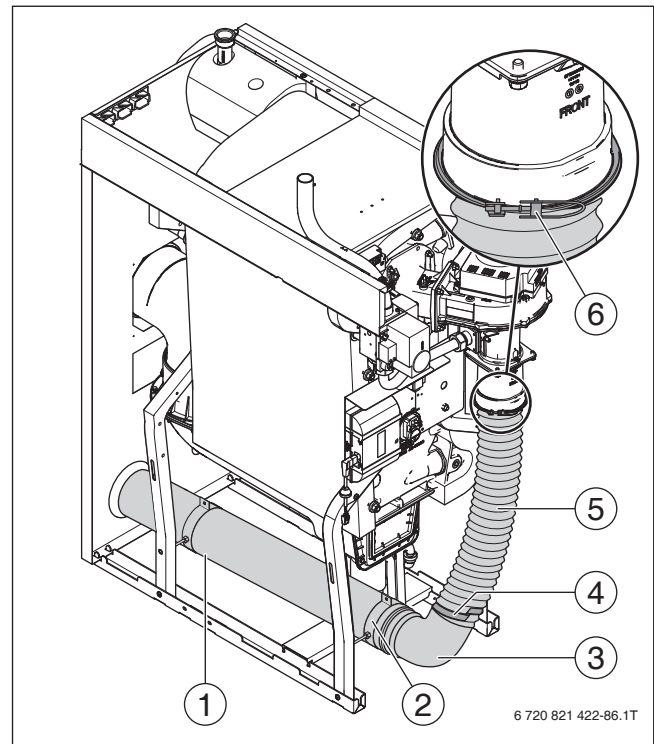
Zubehör-Set für raumluftunabhängigen Betrieb
